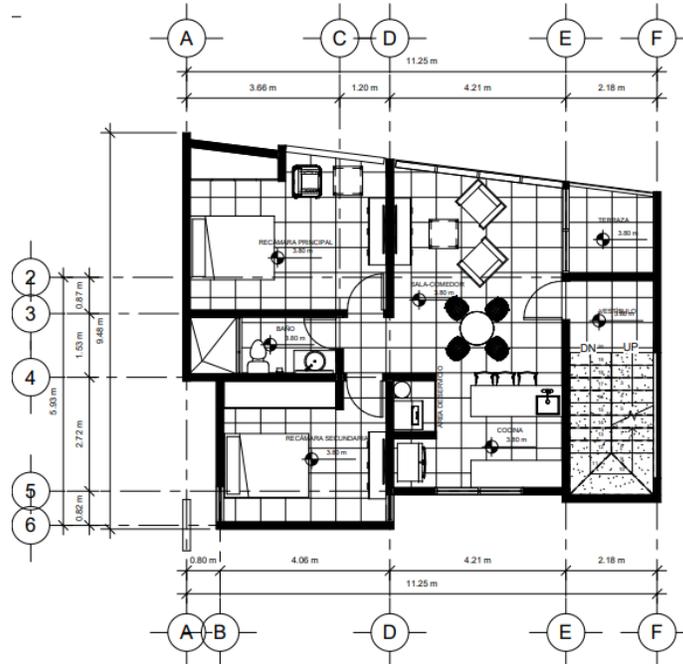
Plano arquitectónico de los departamentos tipo.
